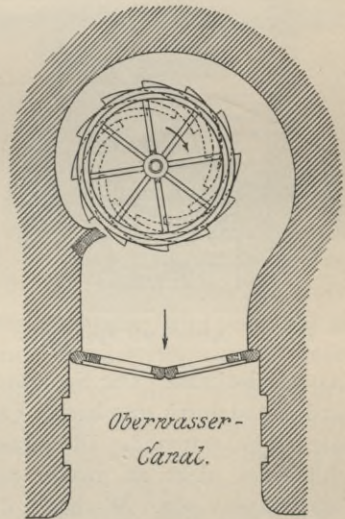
Grundriss der Kreiselpumpe.
